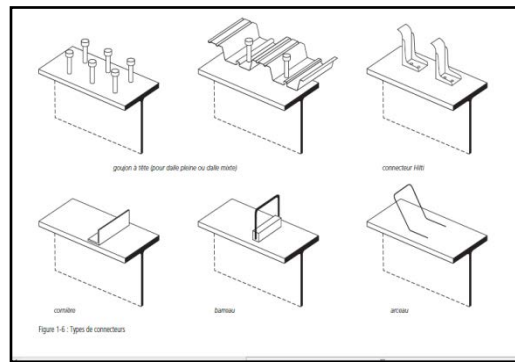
,108 :jonction poutre –plancher dans le cas d'une structure mixte
